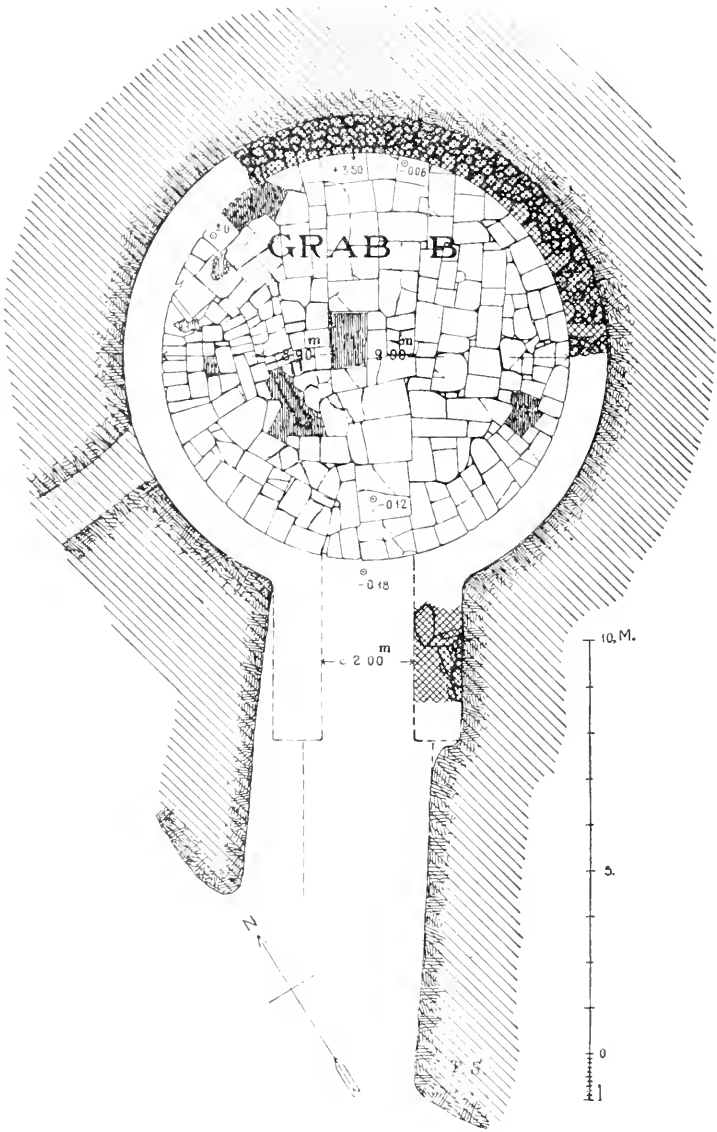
Grundriss des Kuppelgrabes B.
